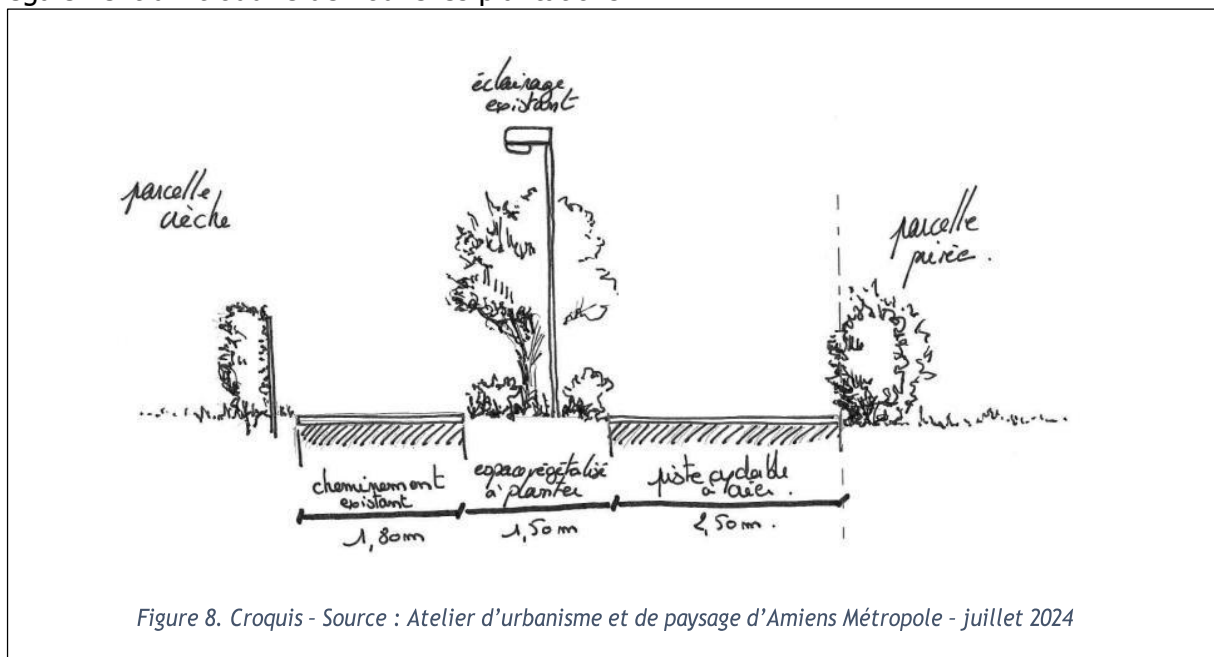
Croquis - Source : Atelier d'urbanisme et de paysage d'Amiens Métropole - juillet 2024
